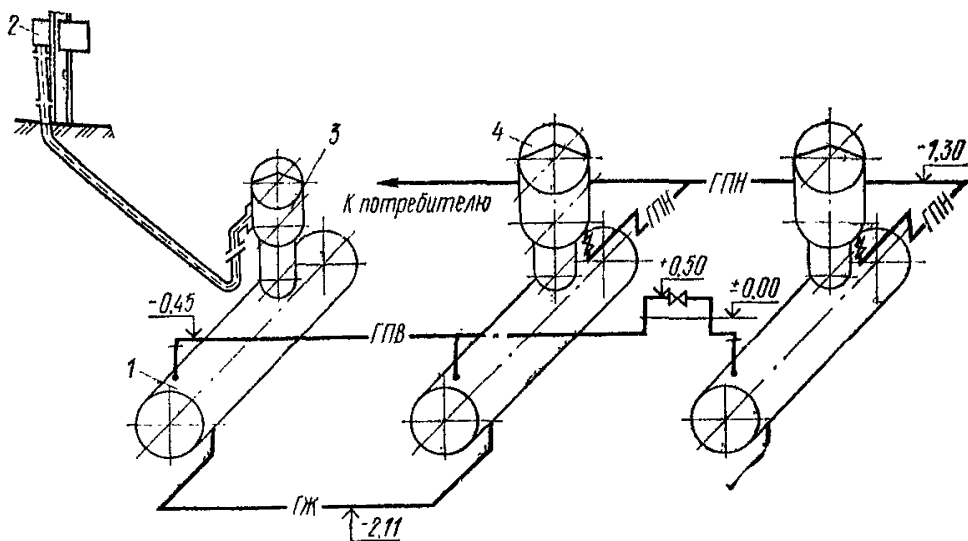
Установка подземных резервуаров с регазификатором РЭП
